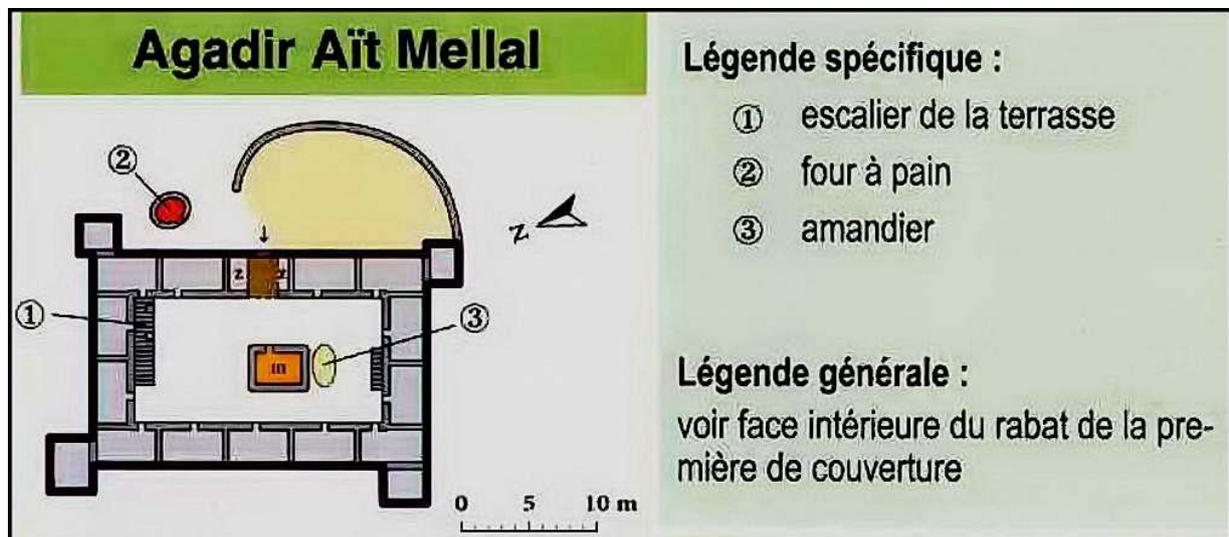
Grundriss des Agadir Ait Mellal; Quelle: Popp, H. et al. 2011
